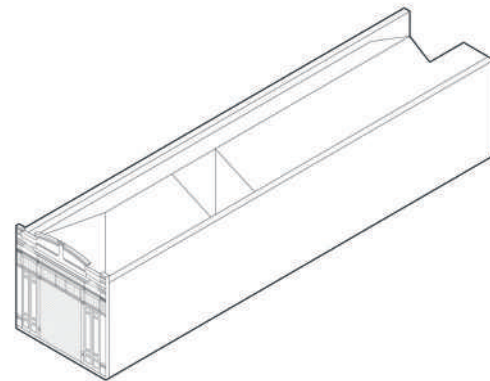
1 construção de armazém e aprovação na prefeitura.
